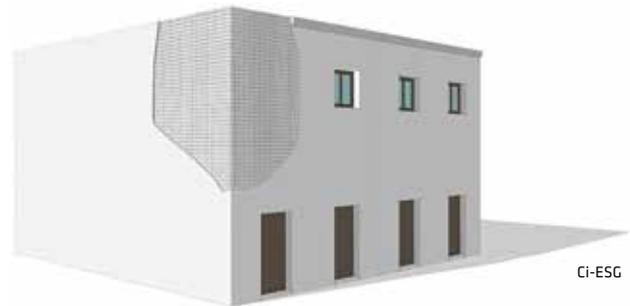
Reforço de parede mediante a aplicação de uma malha Reinforcement of walls with a grid
